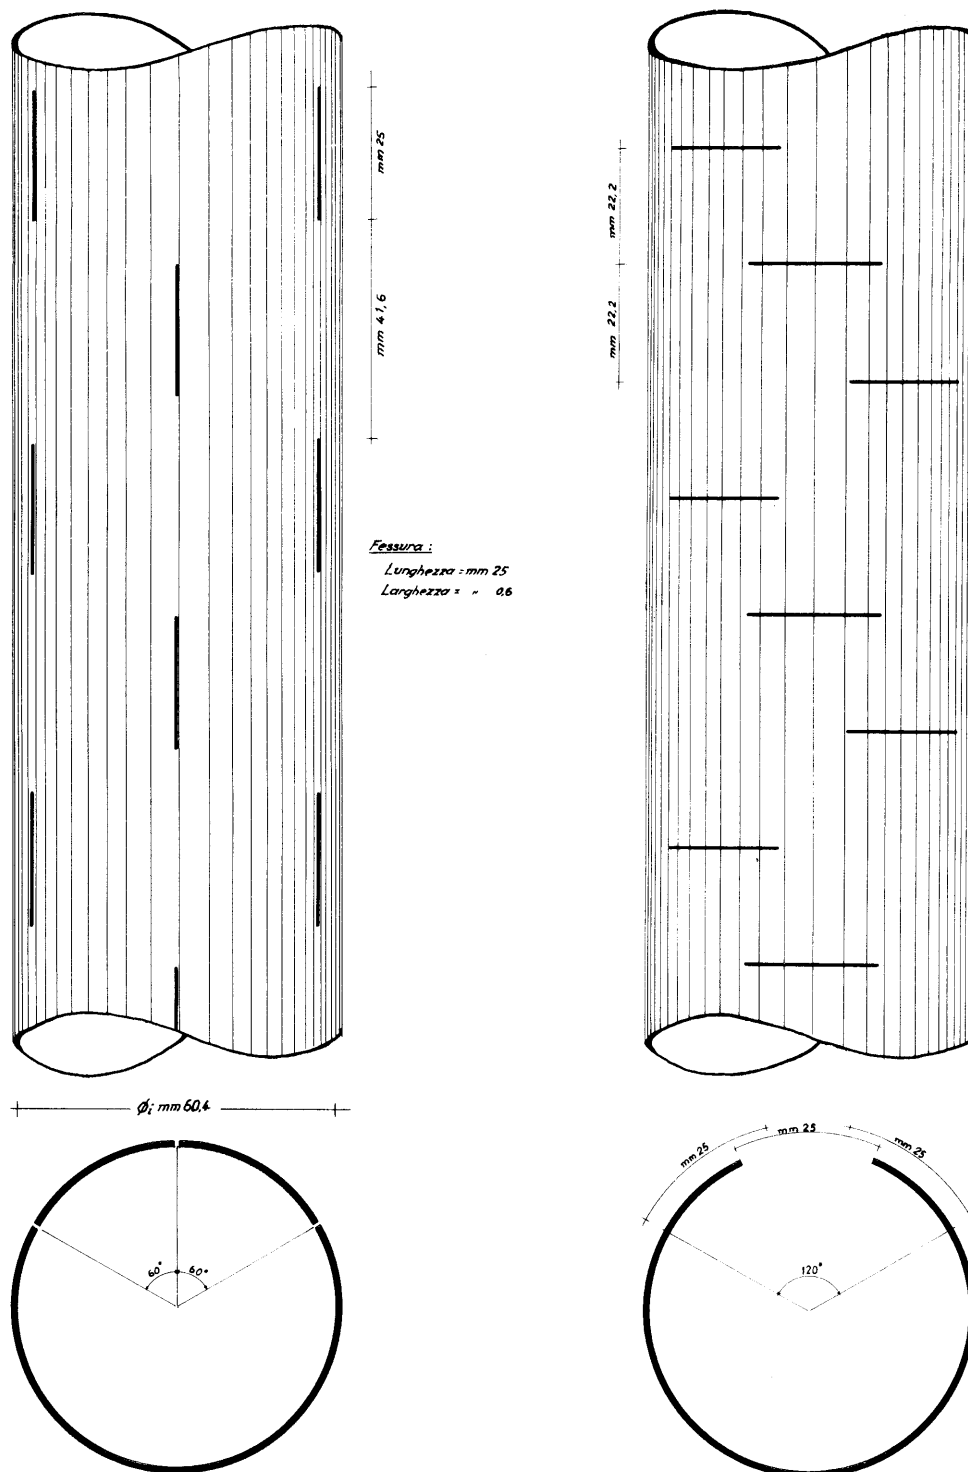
Disposizione delle fessure nei tubi drenanti
